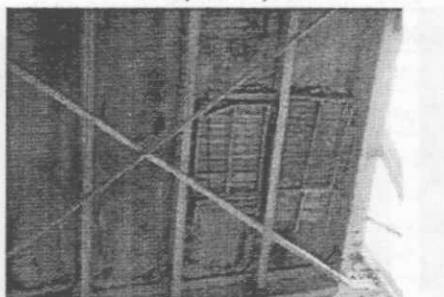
Deficiencias en la construcción. Puente Paso Real (Antioquia).
